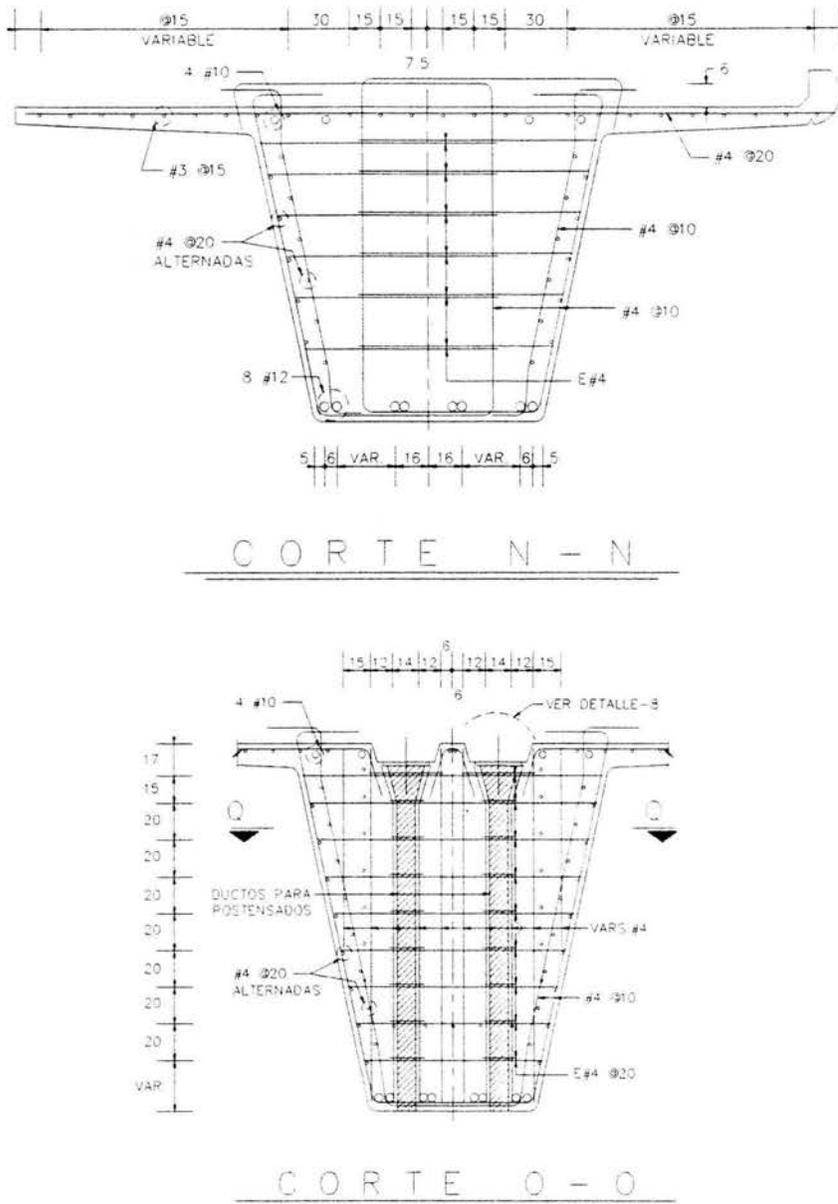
Cortes transversales de las traves de apoyo
